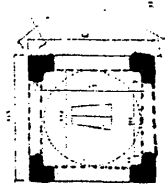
مسقط أفقي لقبة المزني
